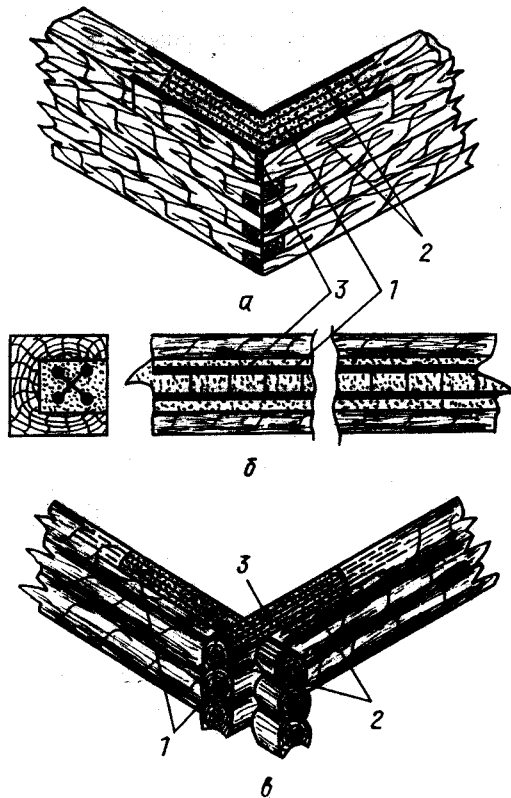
Схемы способов армирования и усиления деревянных конструкций
